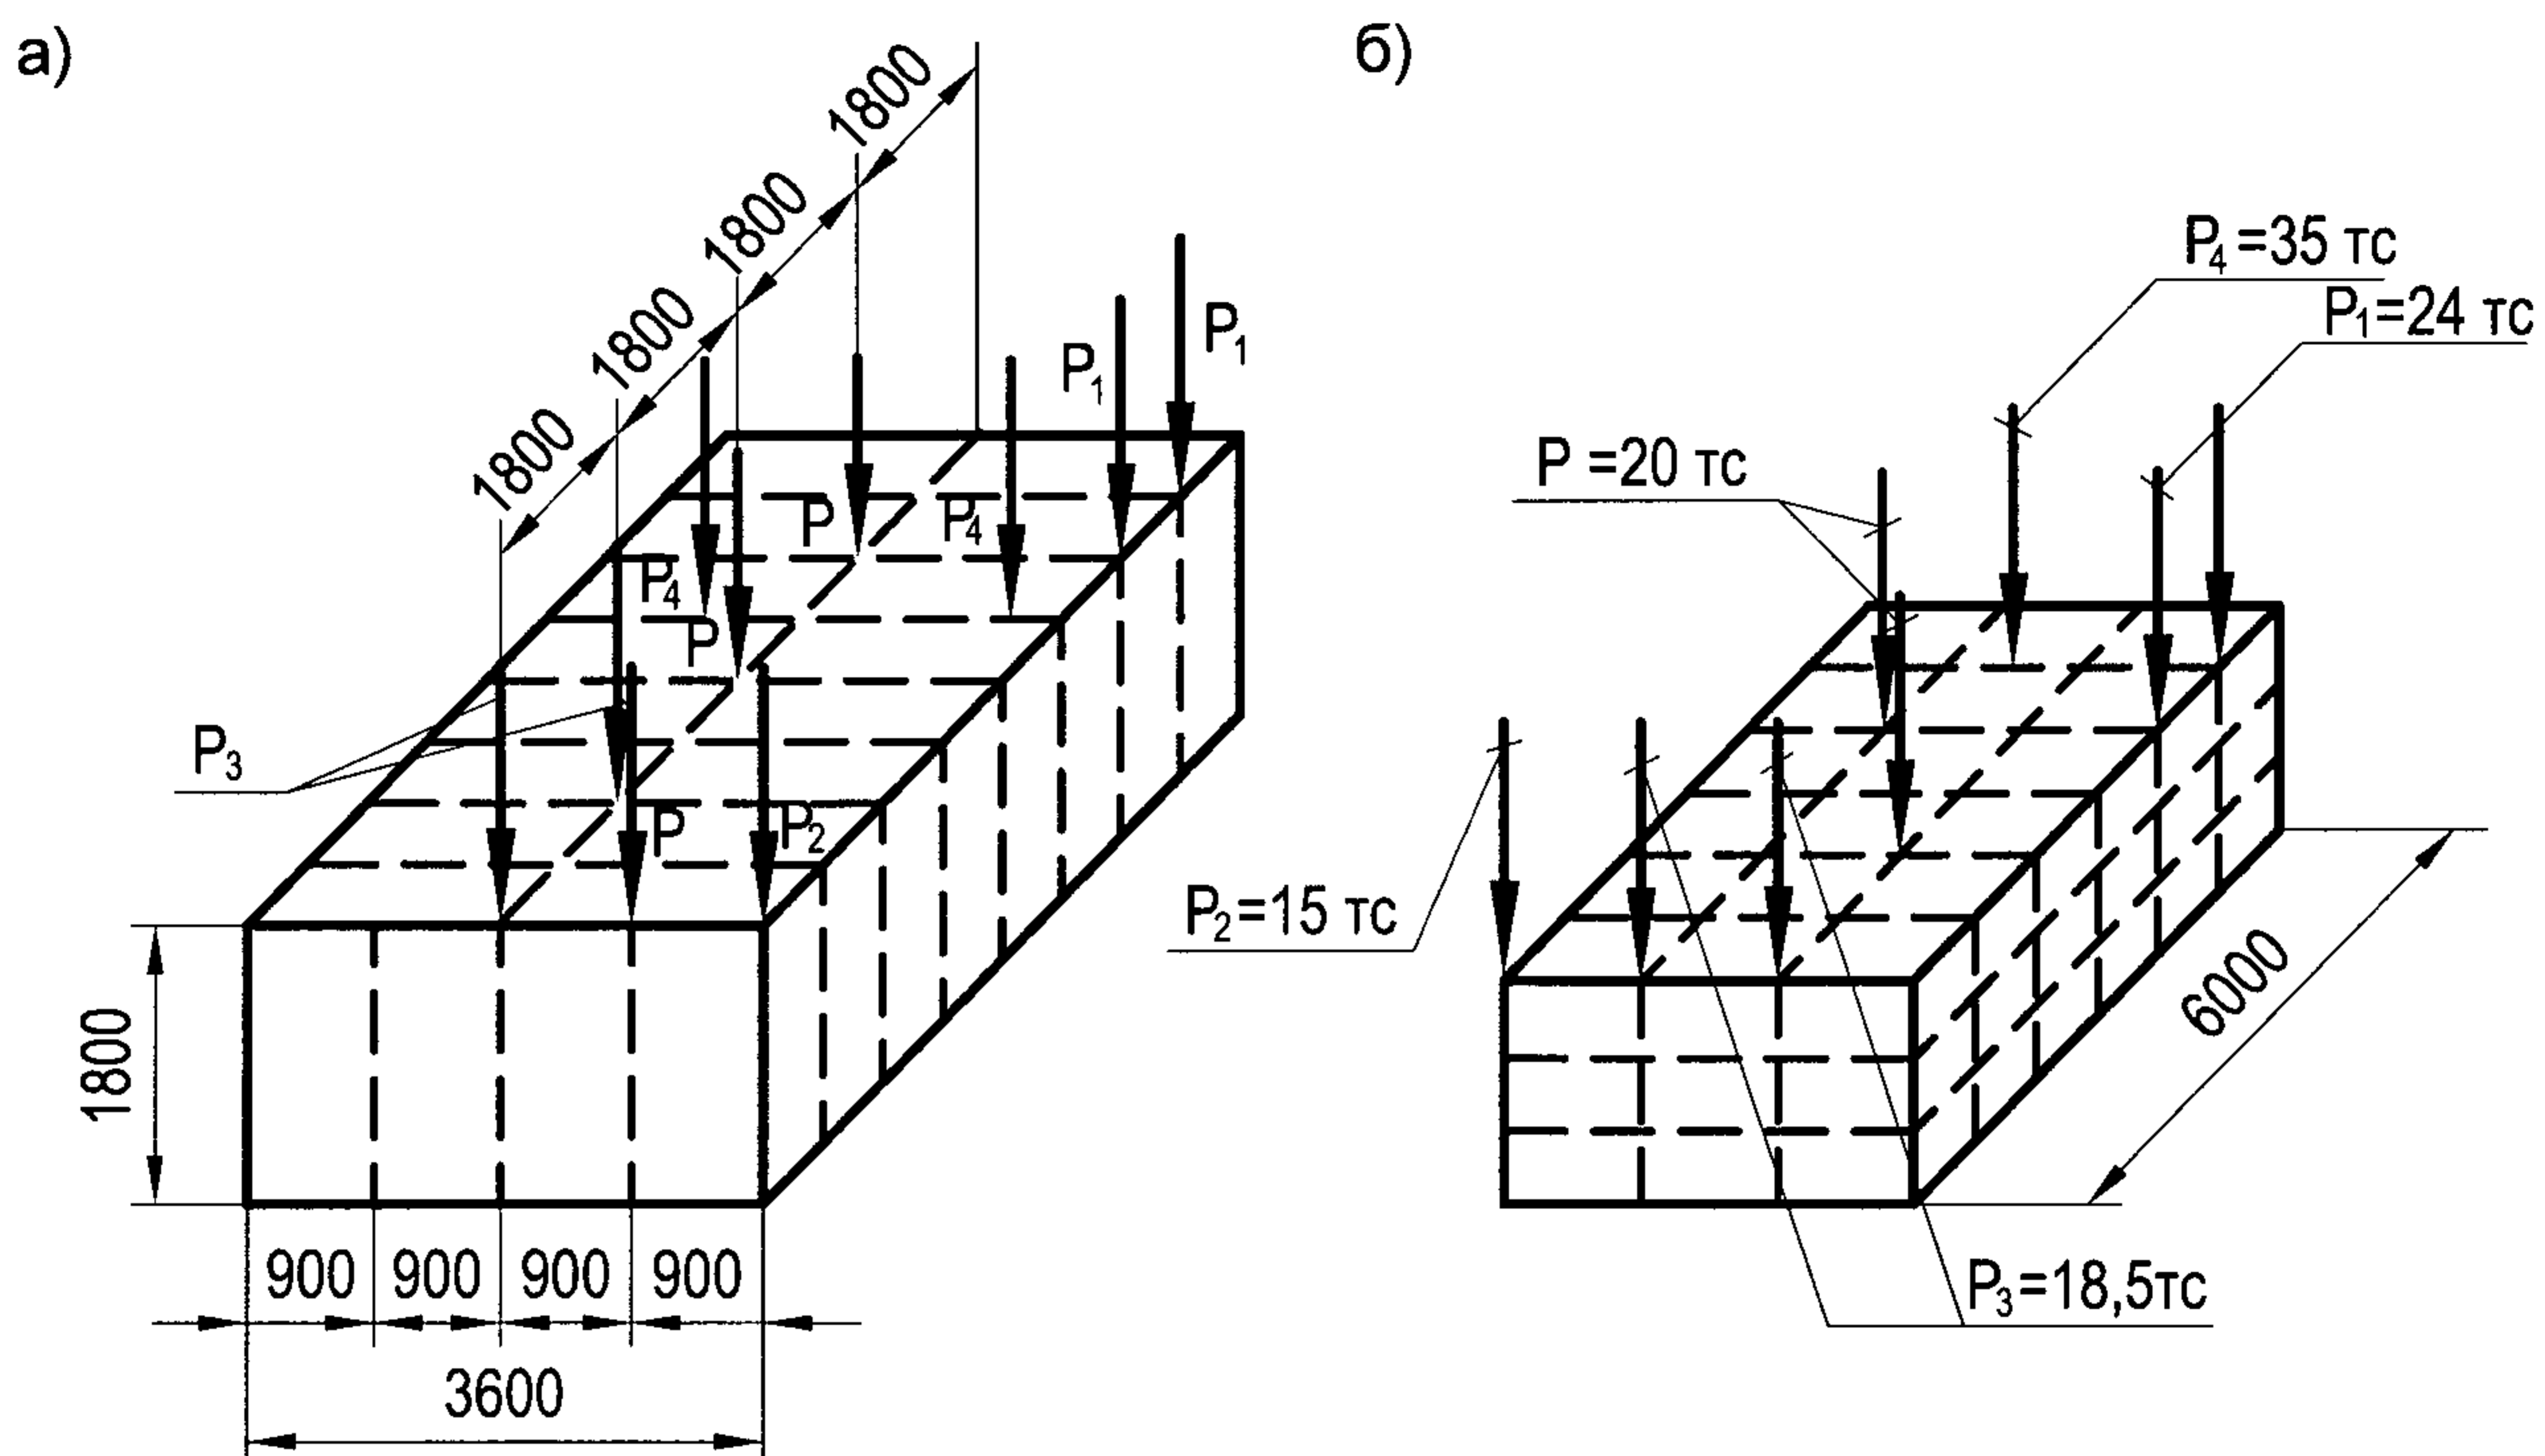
Схема нагрузок на узлы понтонов
